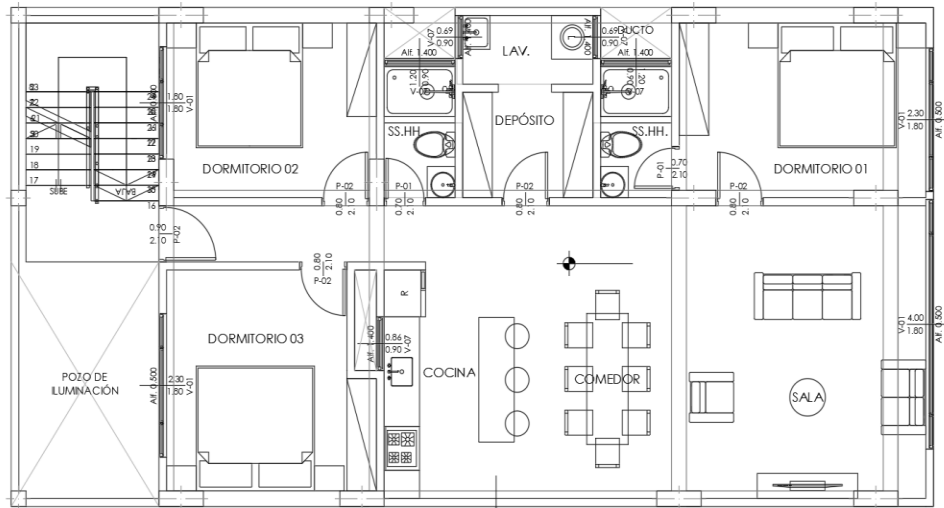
Plano de planta del 2do nivel al 5to nivel.
